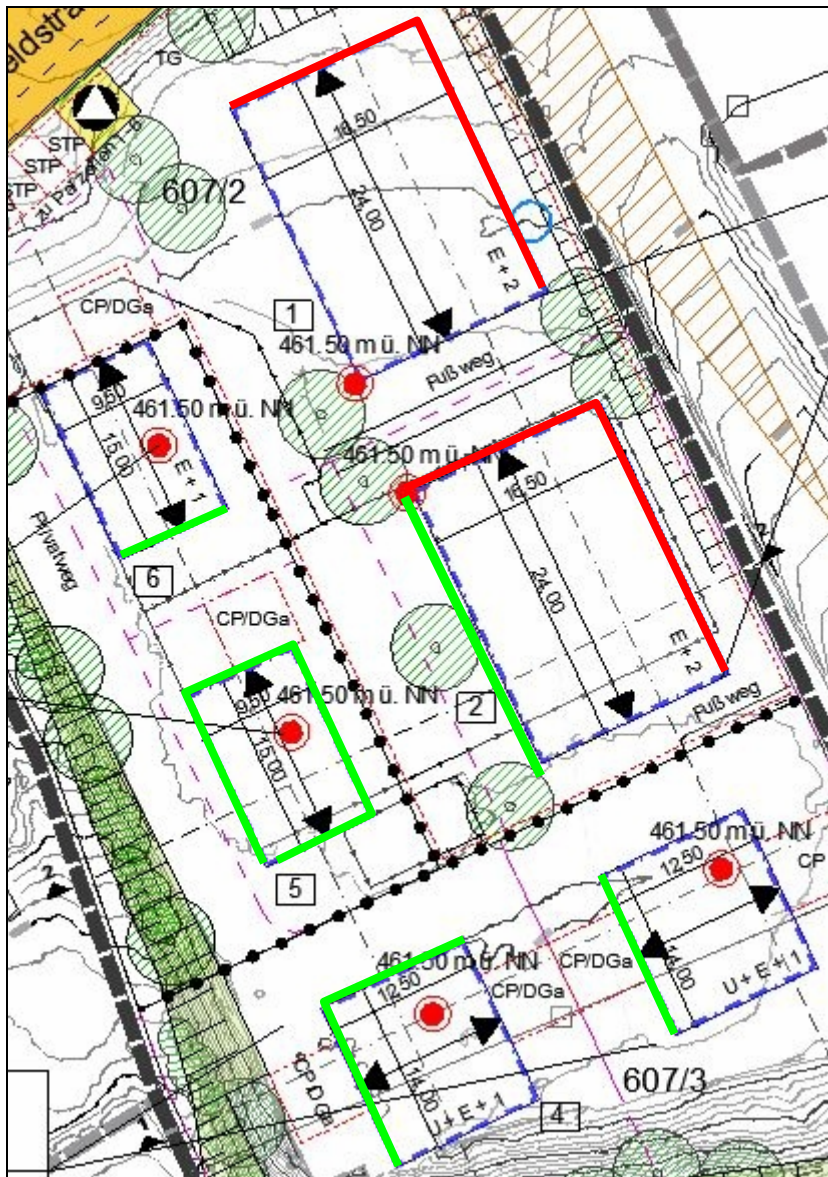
Planskizze; Fassaden mit bzw. ohne Schallschutzmaßnahmen
